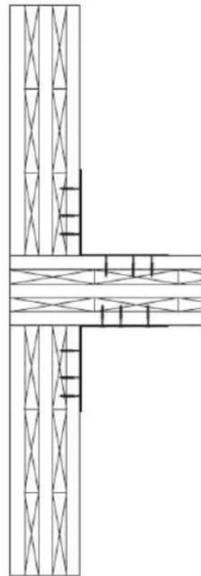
Assemblage mur-plancher par connecteurs tridimensionnels
